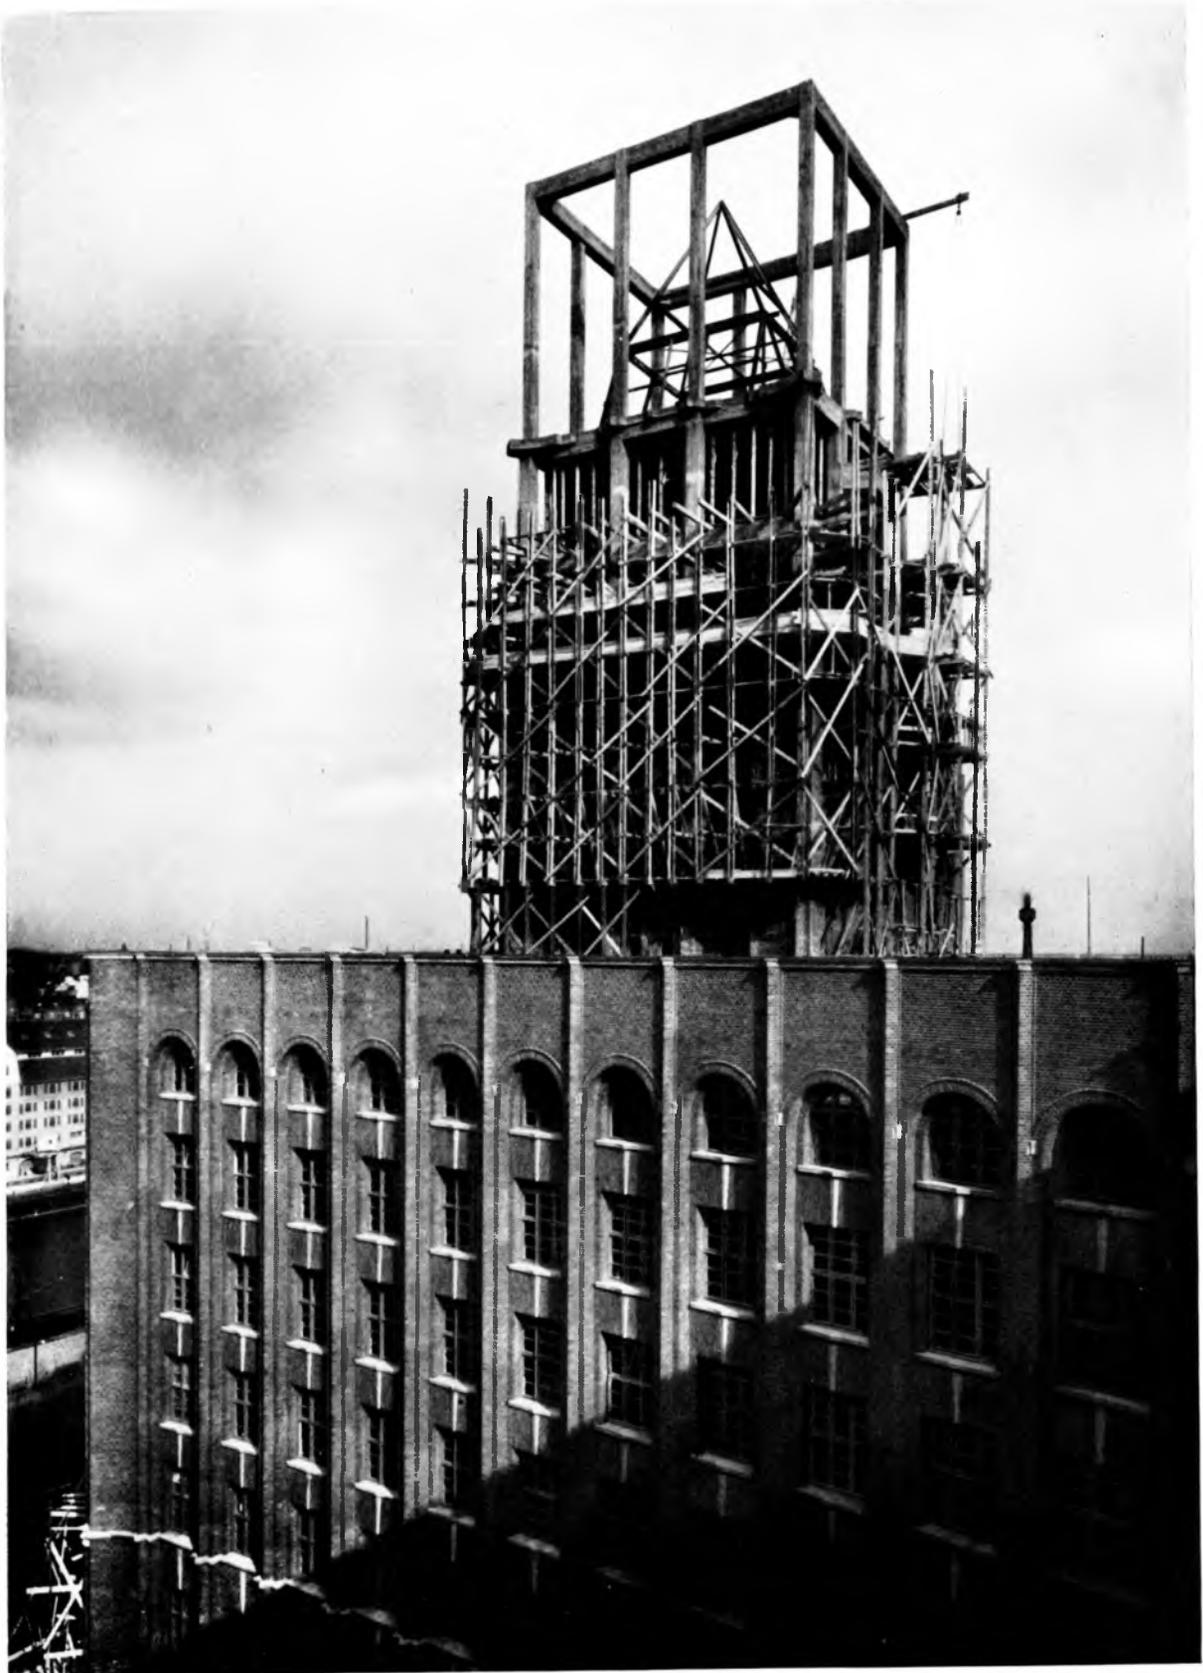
Eisenbetonkonstruktion des XII. und XIII. Turmgeschosses mit dem eisernen Turmdach.
